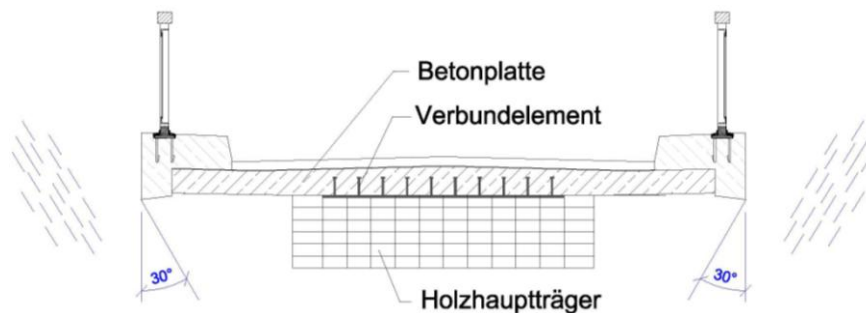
Geschützte Brücke mit oben liegender Verkehrsbahn: Holz-Beton-Verbundbrücke
